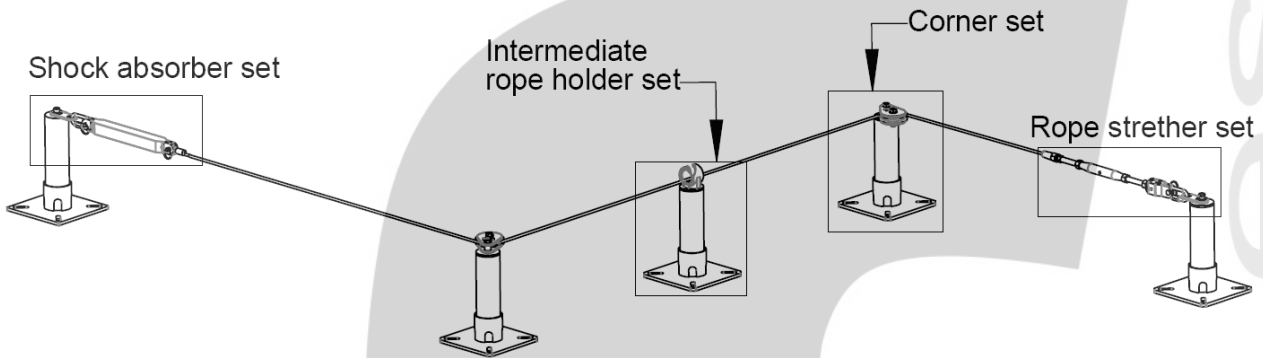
Ejemplo del sistema PRIM instalado sobre postes HL704.
